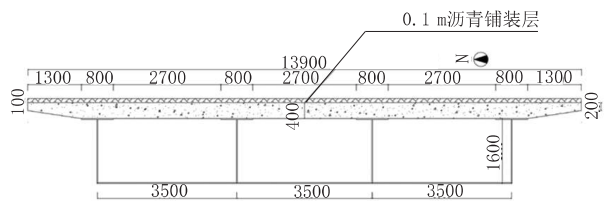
钢箱-混凝土组合曲线梁桥跨中截面示意图(单位:mm)
